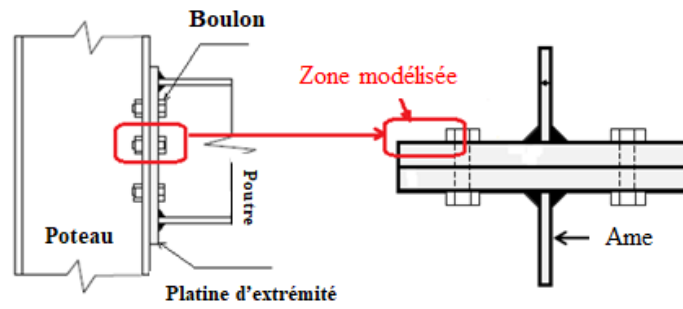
Assemblage boulonné poteau-poutre avec platine d'extrémité.
